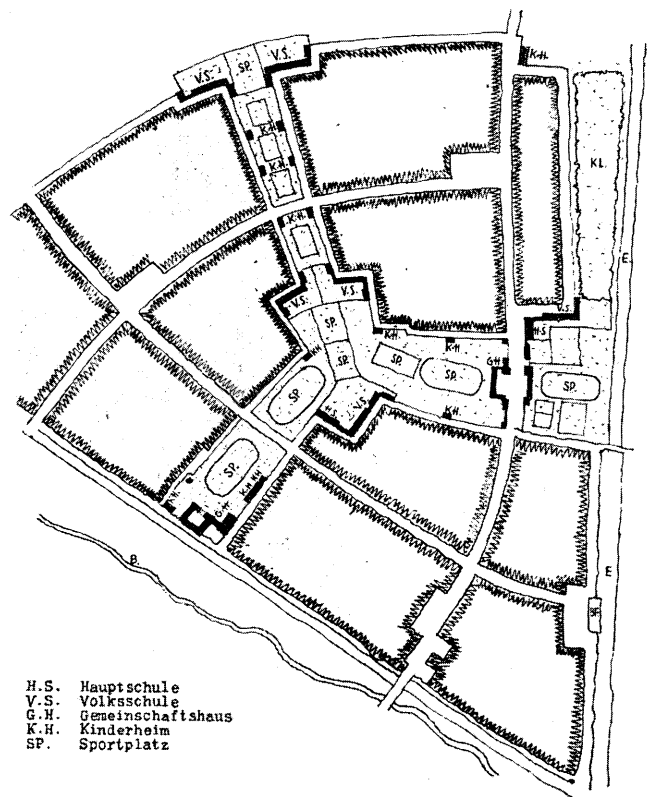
Ausschnitt aus einem Strukturbebauungsplan
